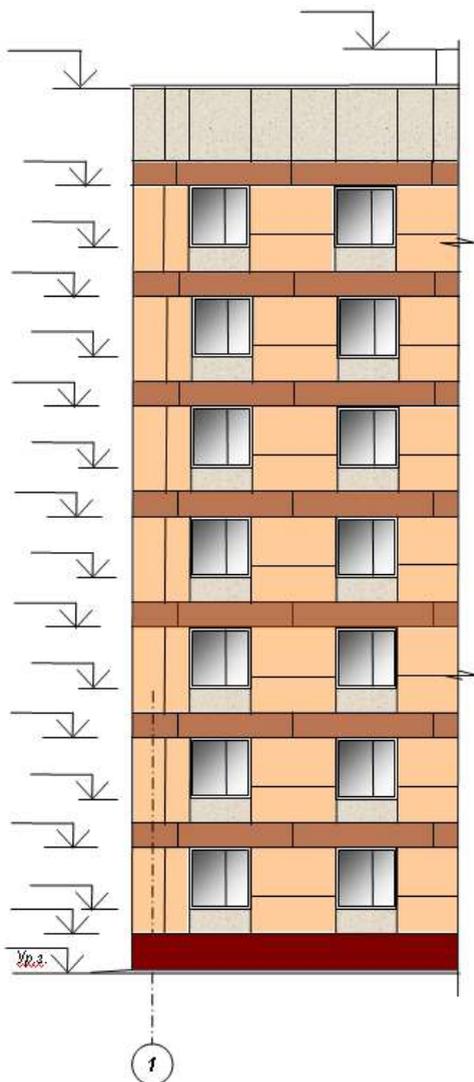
Пример оформления фасада жилого дома со стенами из крупных блоков
